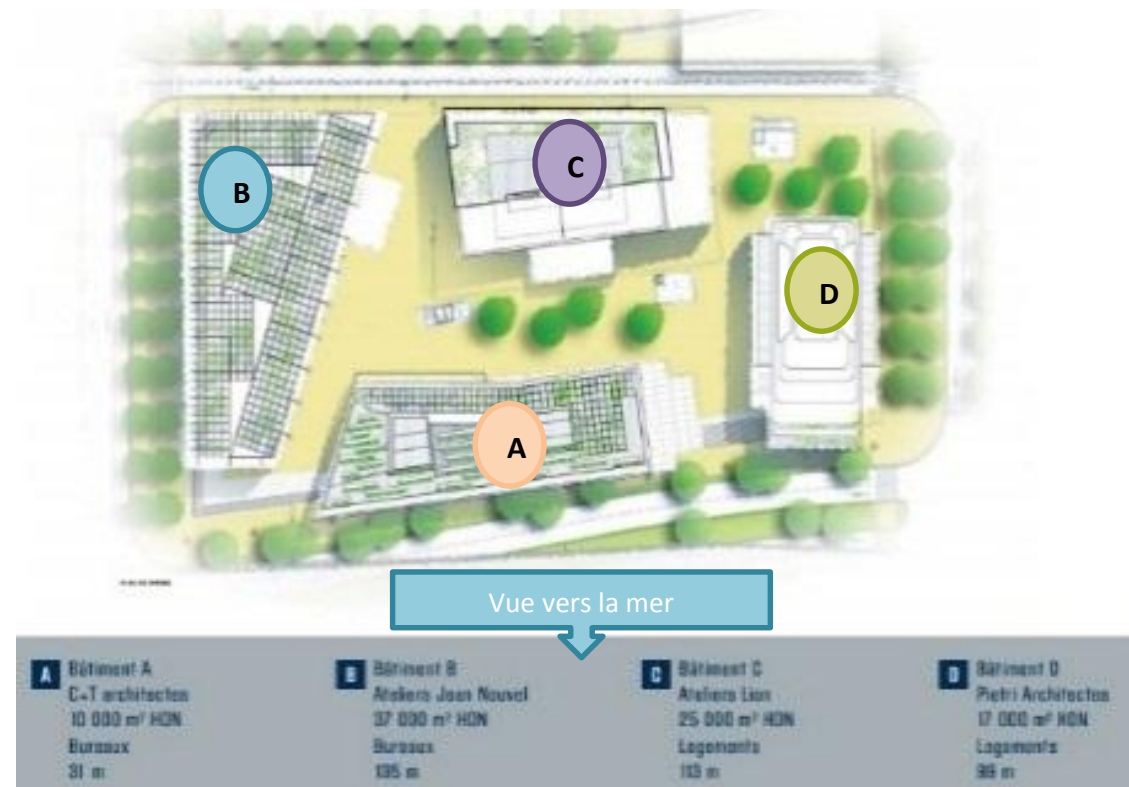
Le plan de masse du quartier d'Arenc : Hôtellerie, bureaux, logements : un projet mixte
